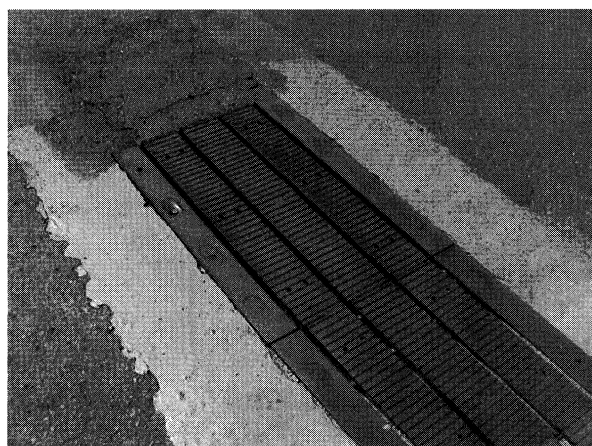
メグナ橋の伸縮装置 (交換された箇所)
